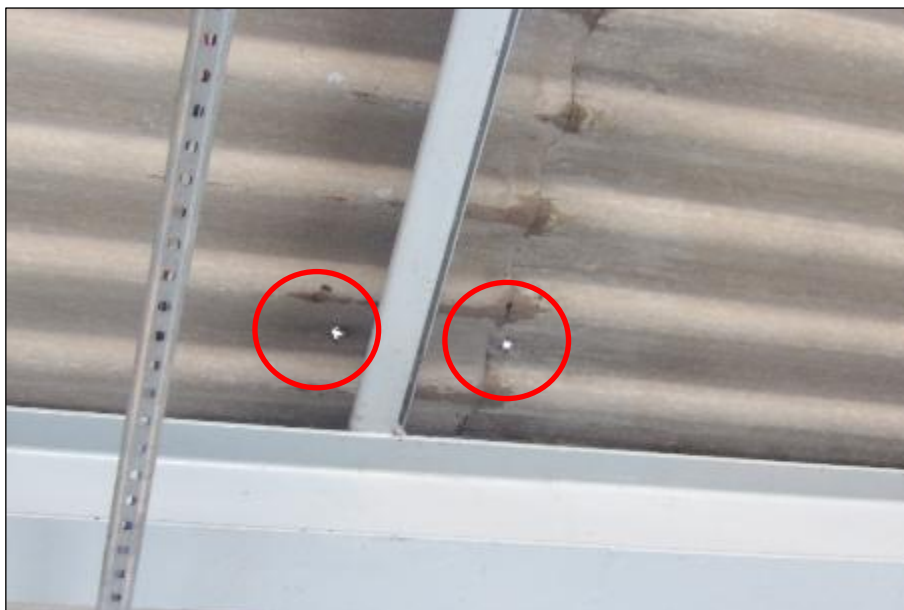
Furos nas telhas de fibrocimento, proporcionando infiltrações e corrosão da estrutura metálica de cobertura.
